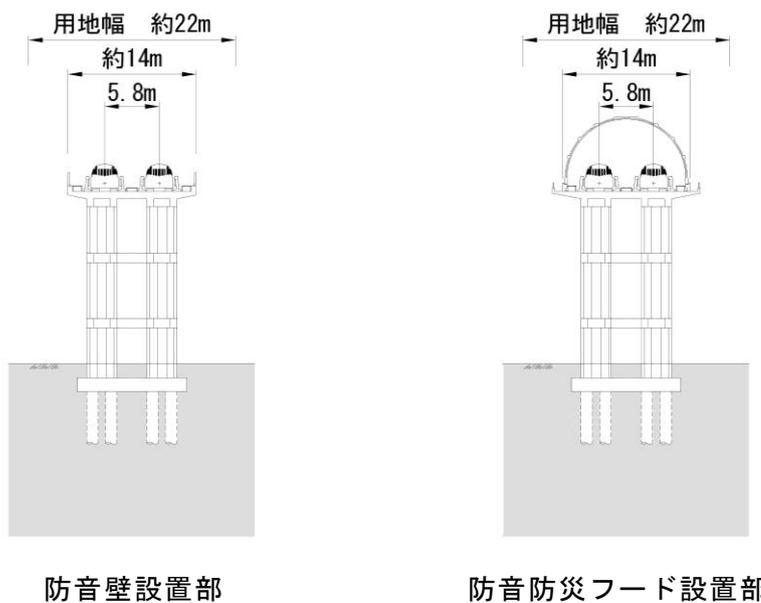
標準的な高架橋（新形式高架橋）の断面図
